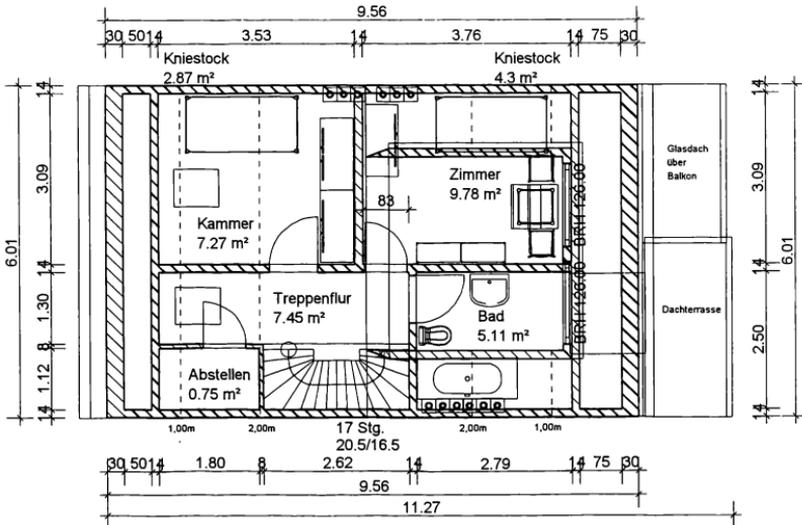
Der Grundriss des Dachgeschosses
